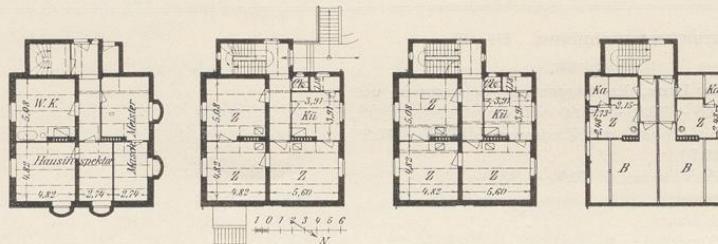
Beamtenwohnhaus. (Kellergeschoß, Erdgeschoß, I. Stockwerk, Dachgeschoß.)
